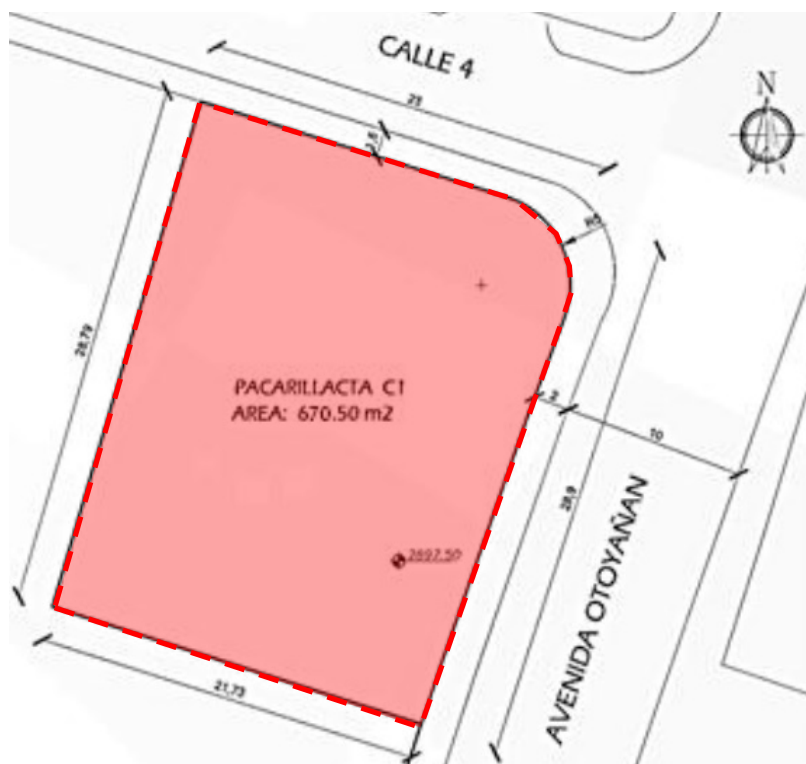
Imagen Plano del terreno propuesto para proyecto de vivienda VIP o VIS –Pacarillacta C1
